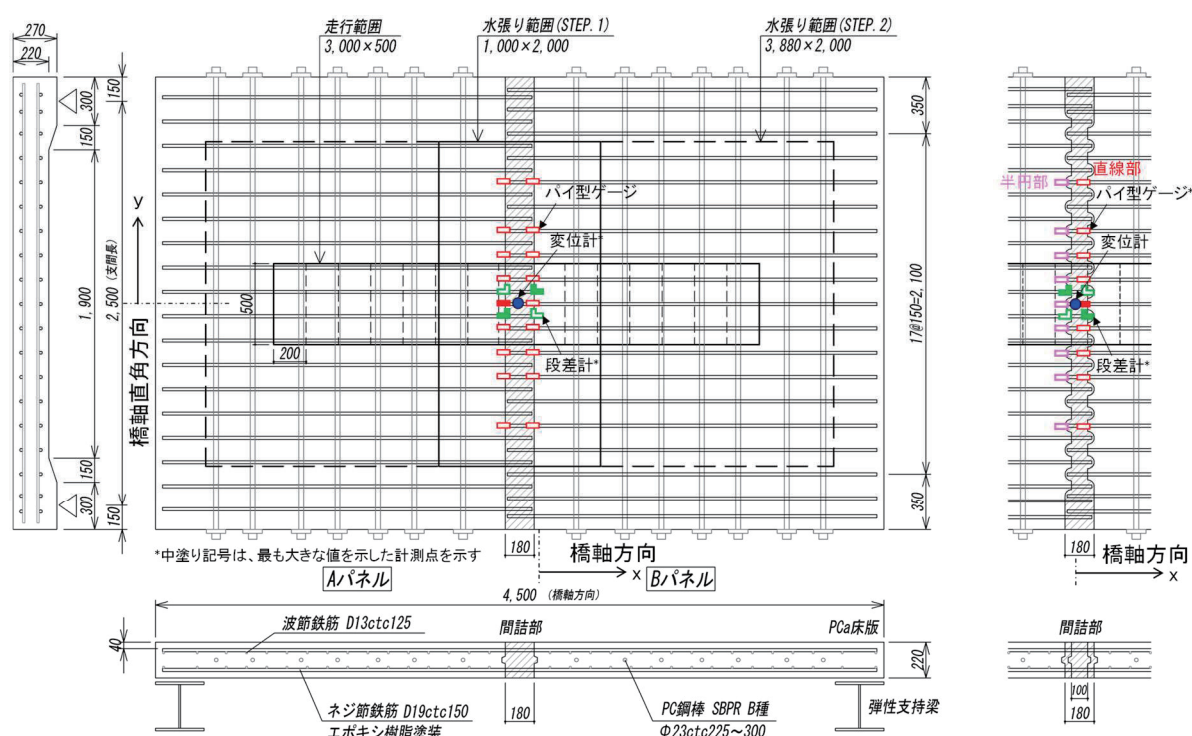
試験体の概要図(左:直線形, 右:半円形) [単位:mm]
